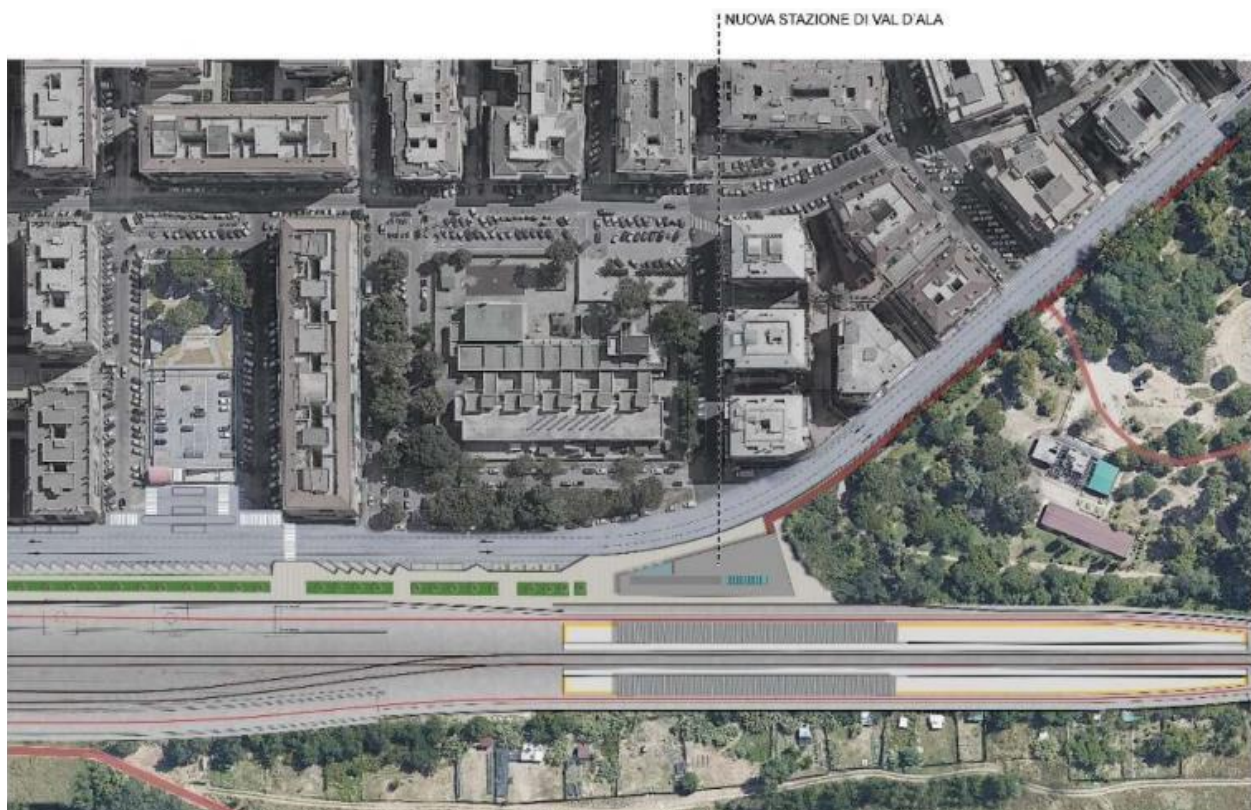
Stazione di Val d'Ala - Layout generale di progetto
